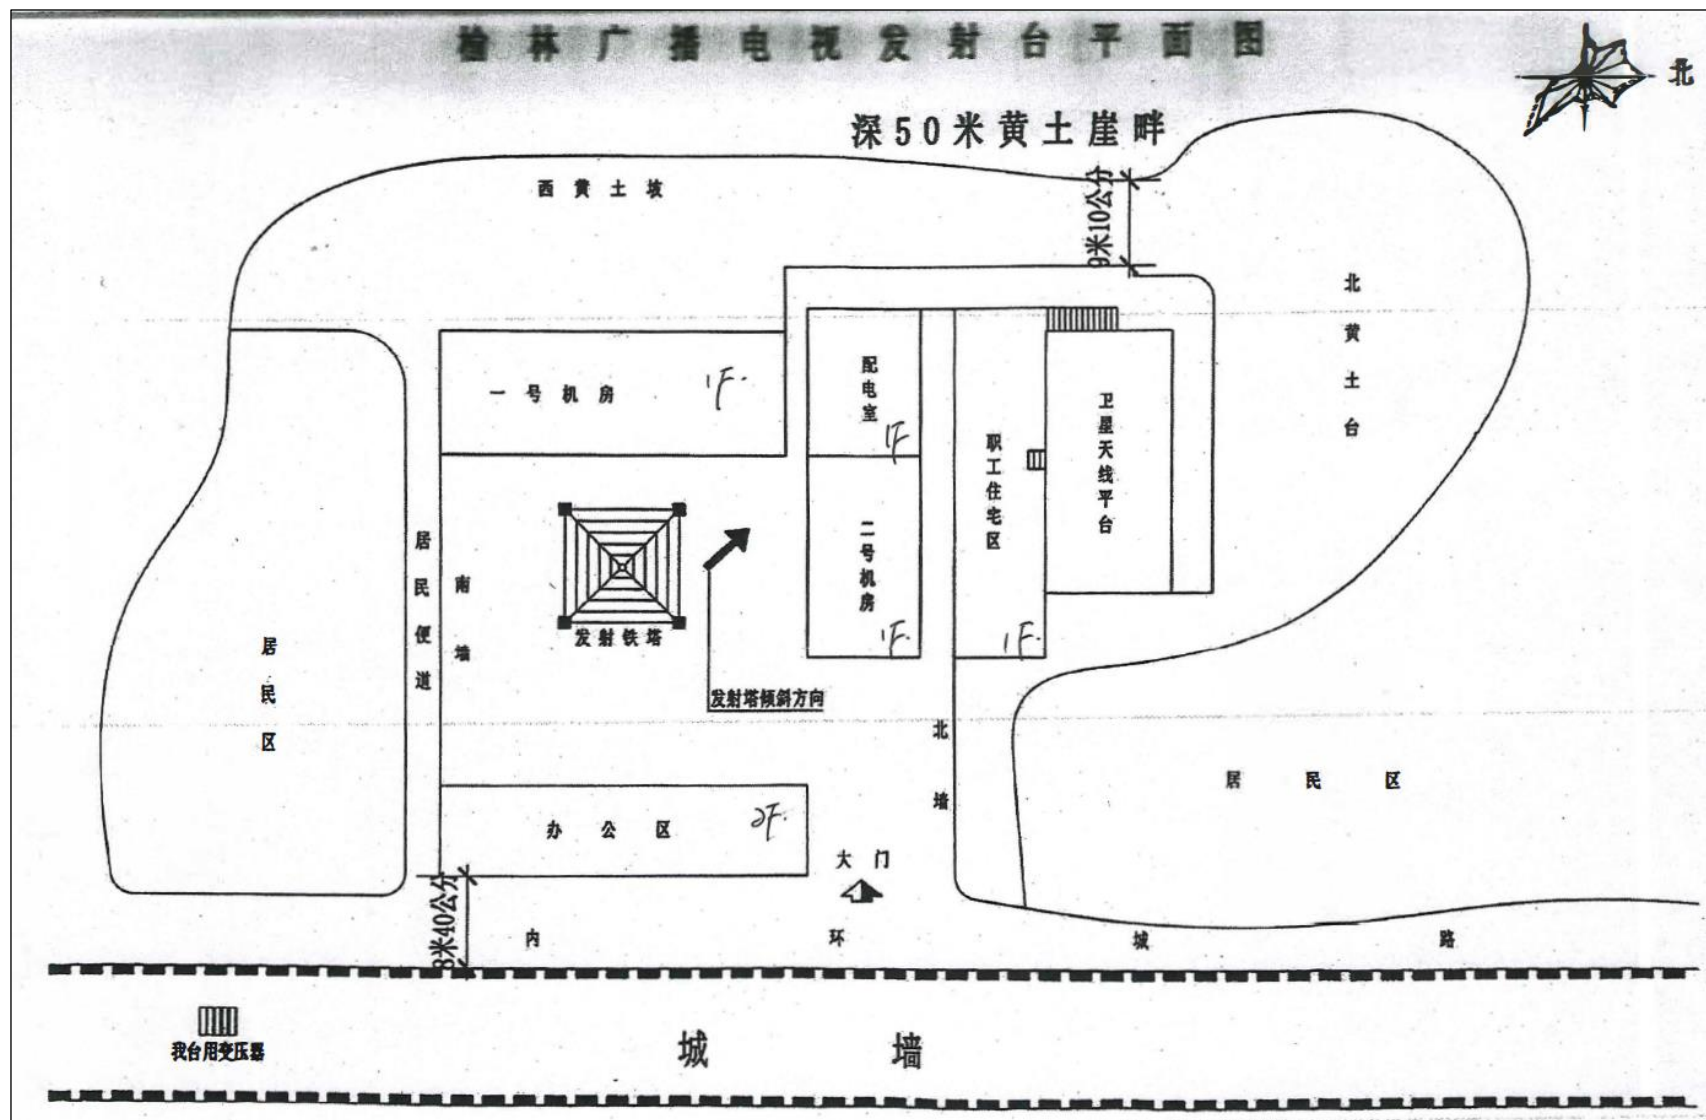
榆林广播电视发射台现状平面布置示意图
